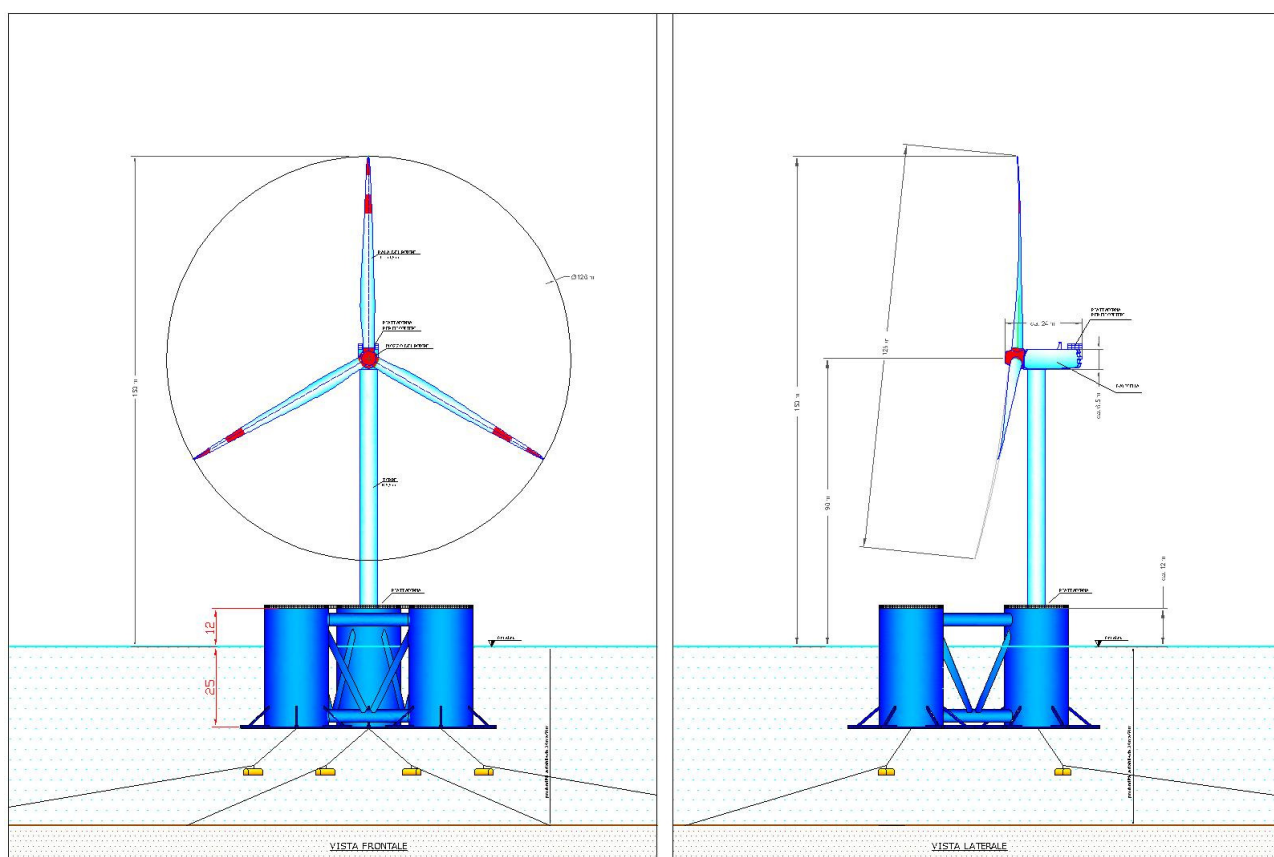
Prospetto dell'aerogeneratore di progetto
